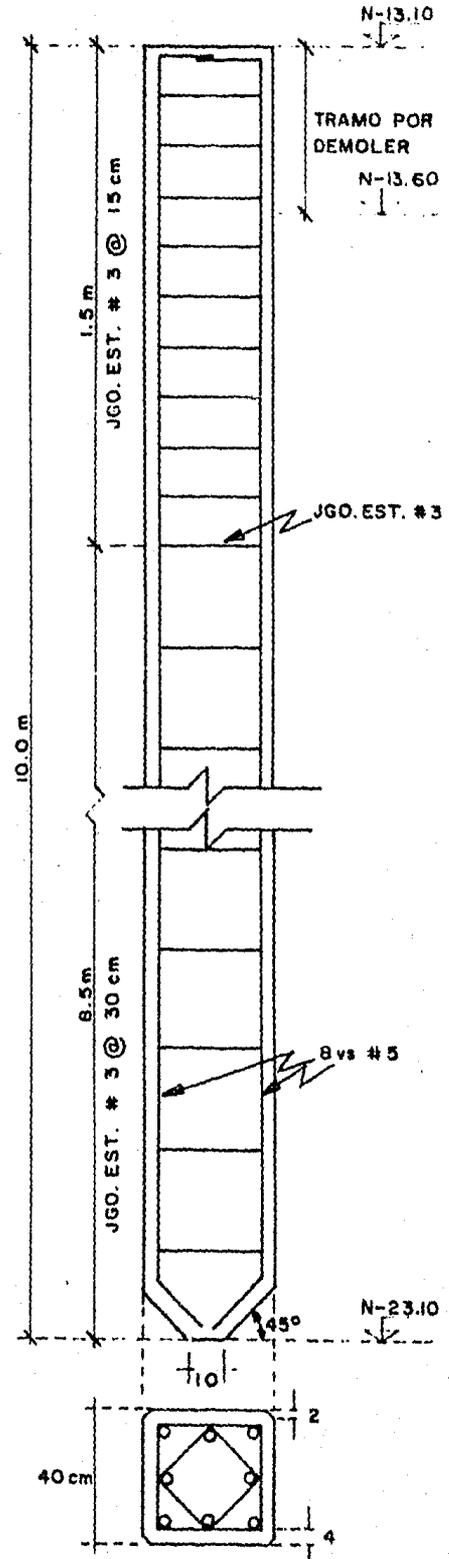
DISEÑO ESTRUCTURAL DE PILOTES.
